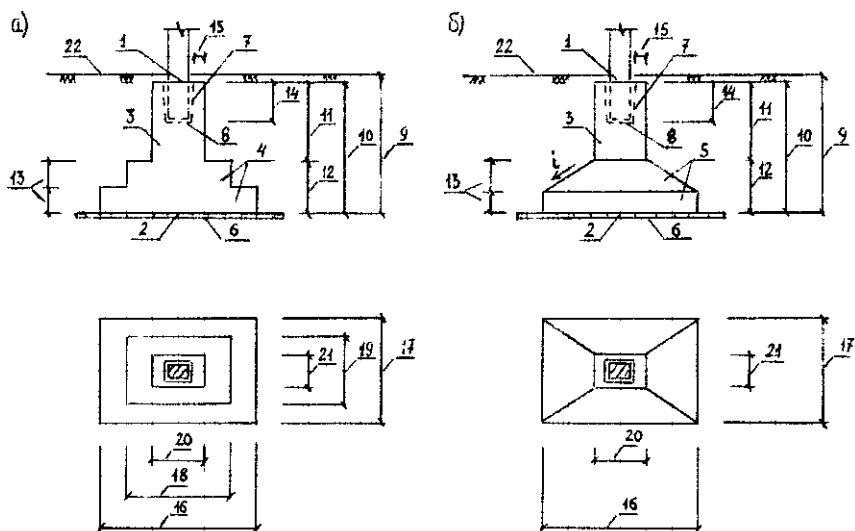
Конструктивные элементы отдельного железобетонного фундамента: а – монолитного, б – сборного.
